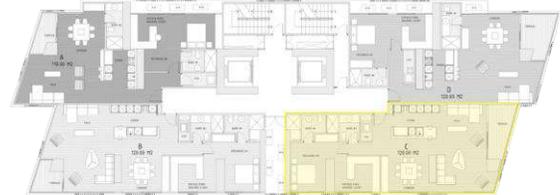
Planta arquitectónica PH Quartier del Mar (Planta Arq. y Orientación).
